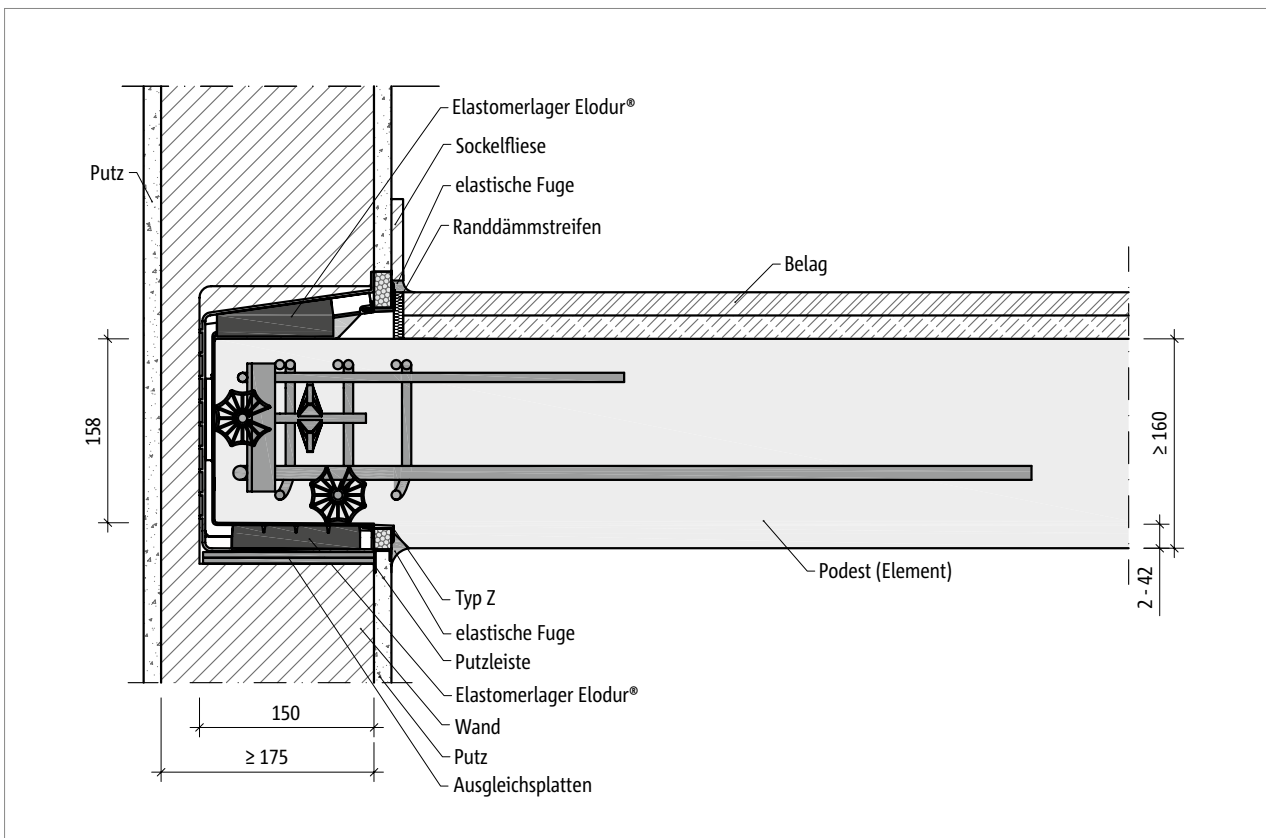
Schöck Tronsole® Typ Z-V+V-T: Einbauschnitt Fertigteilepodest
